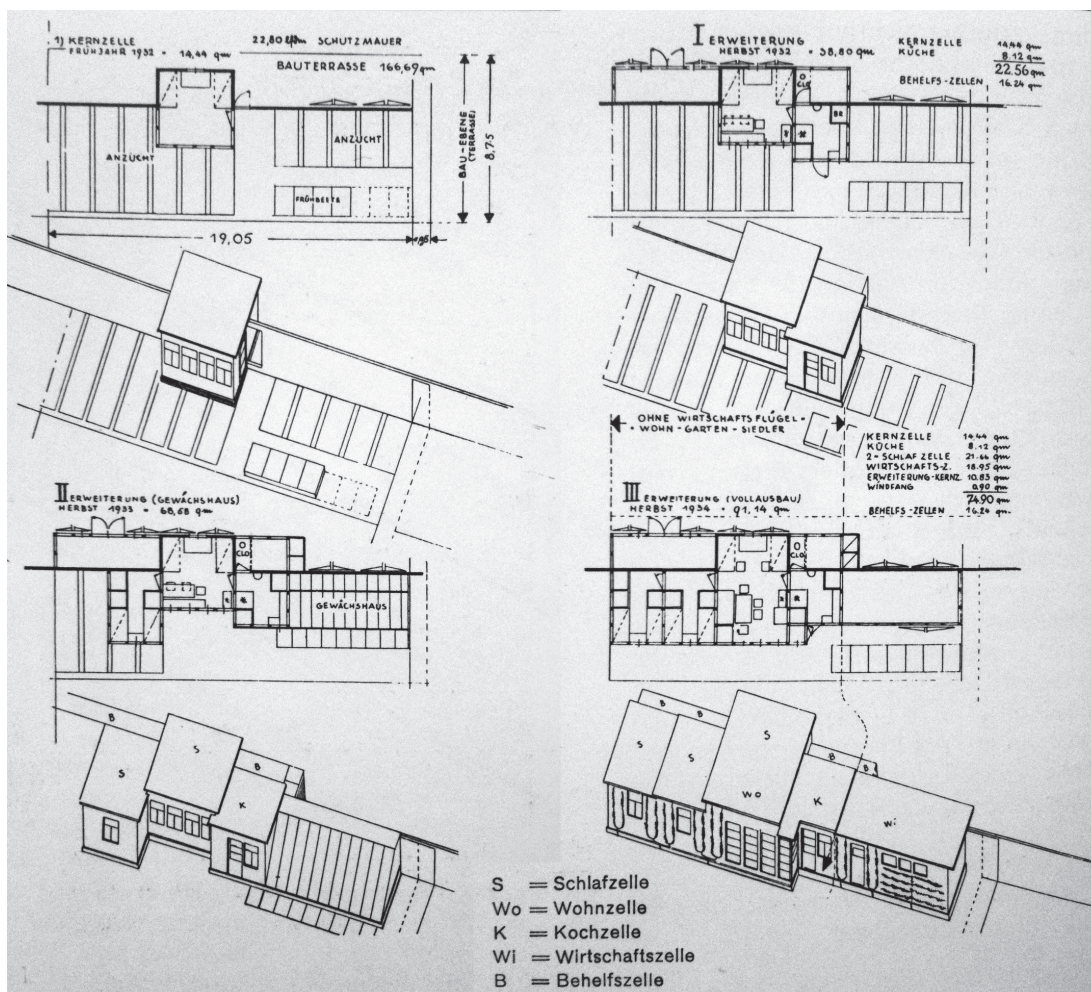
Proyecto de construcción en tres fases de la Wachsende Haus. Martin Wagner y Leberecht Migge.
